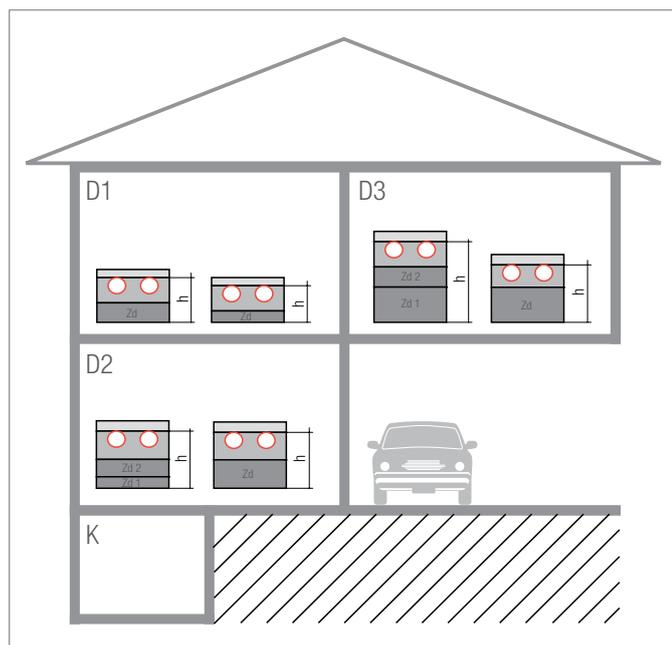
Epaisseurs de chape minimales d'un système de plaque de base TS-14
